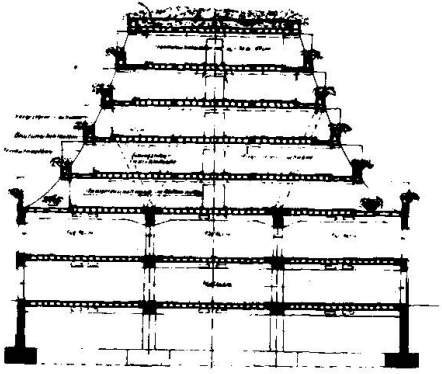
Terrassenaufbau über steilwandigem Gebäude.
